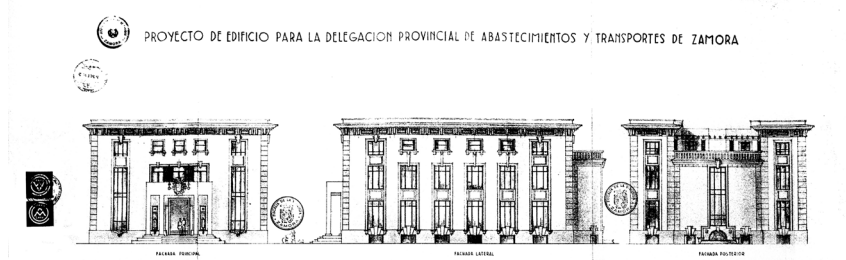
DPAyT. Detalle del plano de alzados y secciones. AHPZa. DPV. 10/23. Foto: RAG-L
